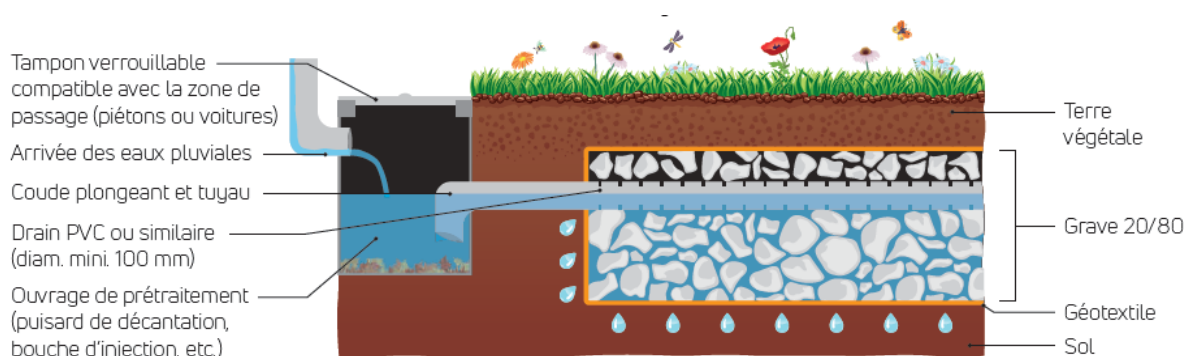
Coupe longitudinale d'une tranchée en gravier non traitée avec injection localisée
